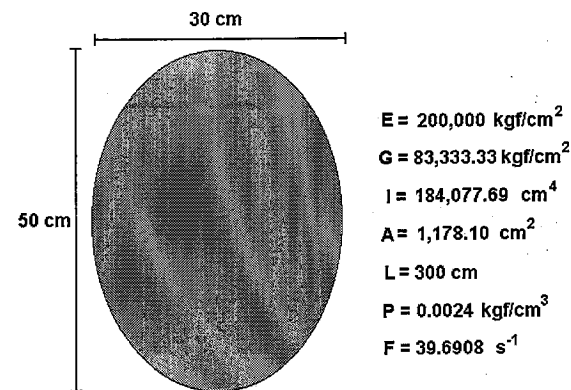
Sección transversal de una viga de concreto elíptica.
